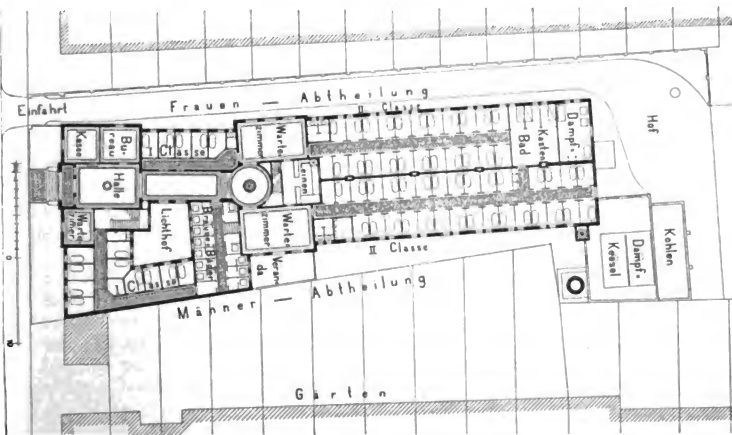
Grundriß der neuen Badeanstalt am Steffensweg. Gildemeister und Sunkel. 1898.
